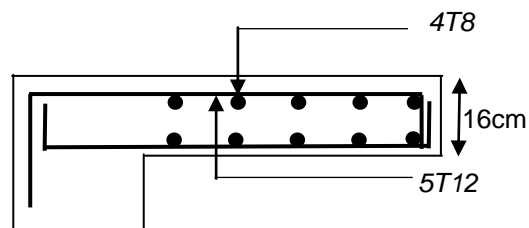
Schéma de ferrailage de la porte à faux (terrasse)
